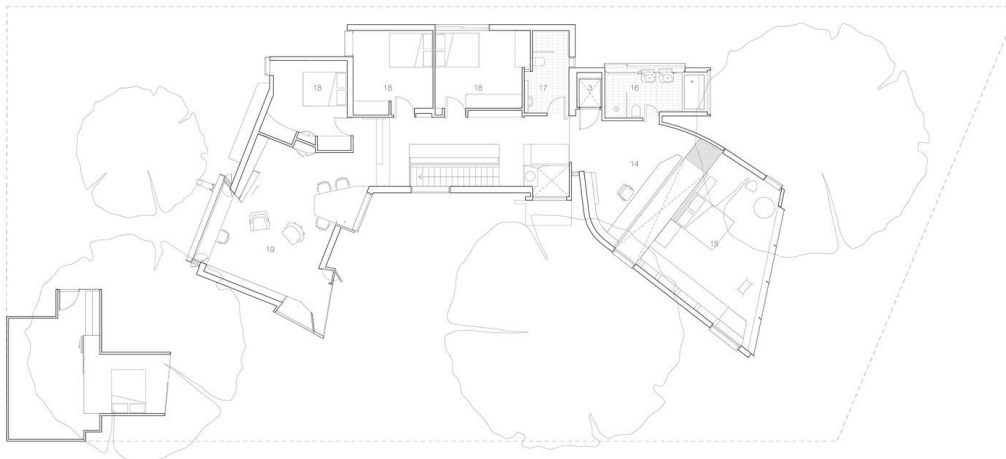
Planta do piso 1, Kew House. Fonte: ArchDaily, Autores: John Wardle Architects
